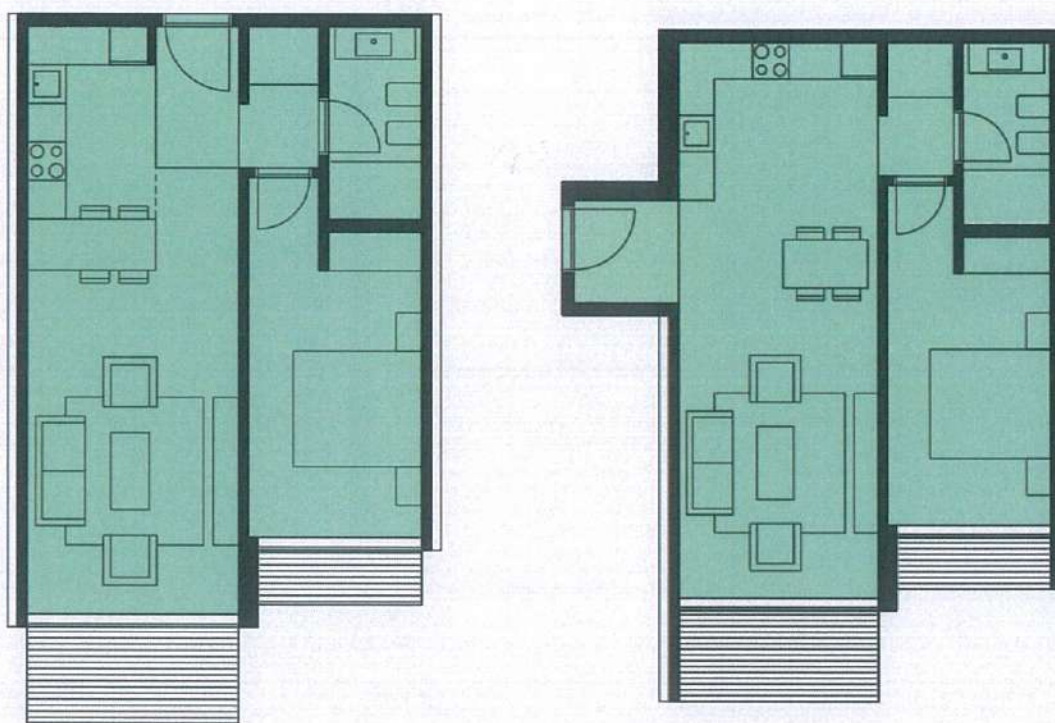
Planimetri e Apartamentit Tip 1+1 - Nënvariante
